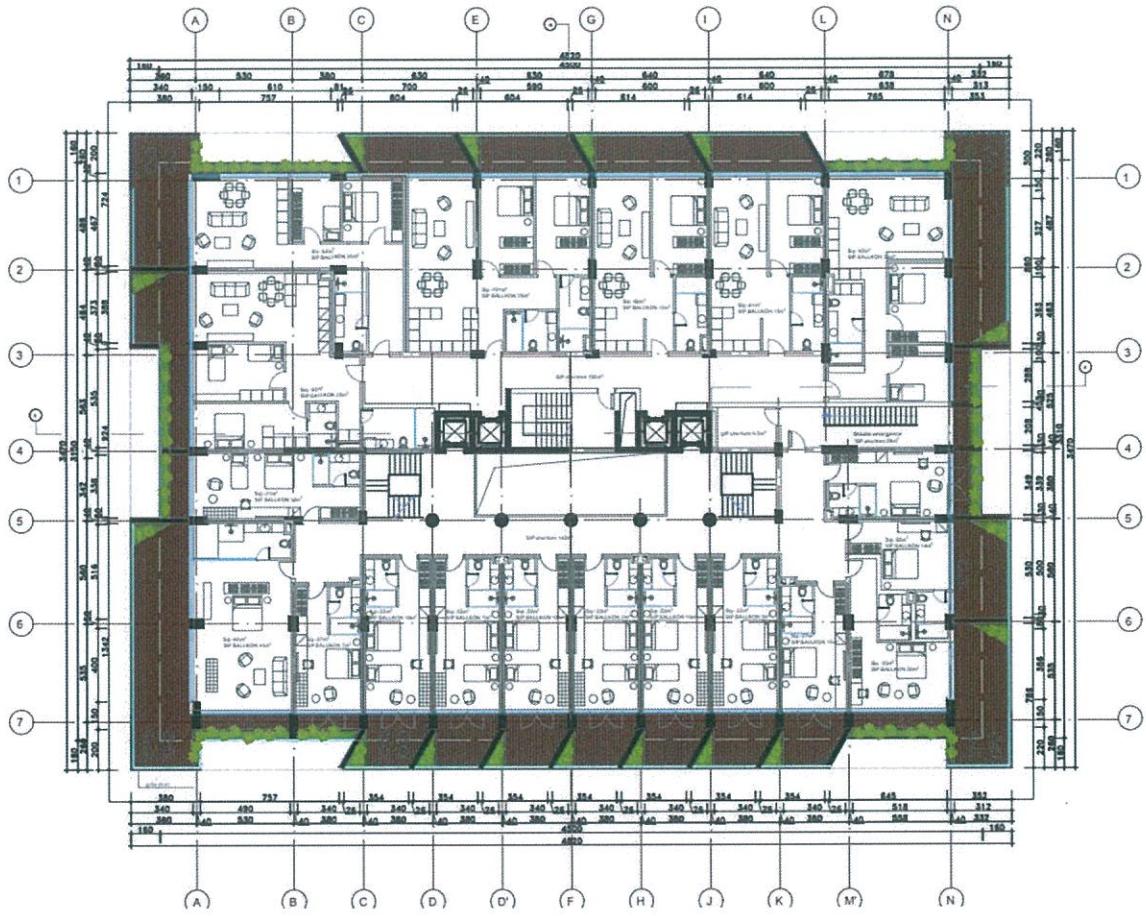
Planimetria e kosit tip sezioni 1 dhe 2
